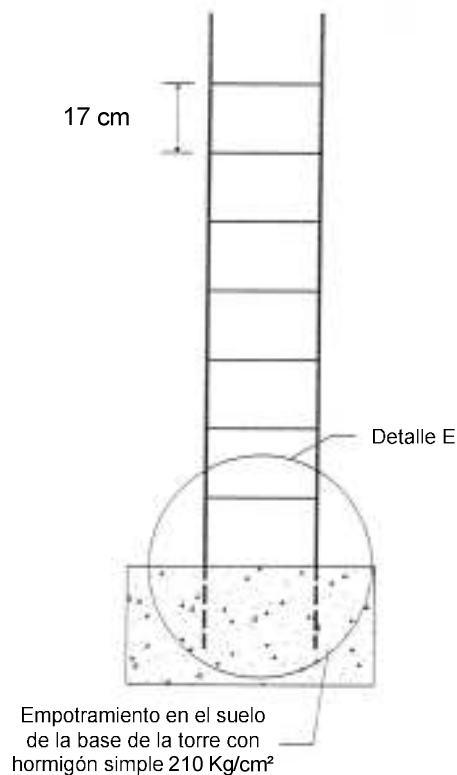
Detalle B, Escalerilla para cables de sistema de RF y sistema de Tierra.
